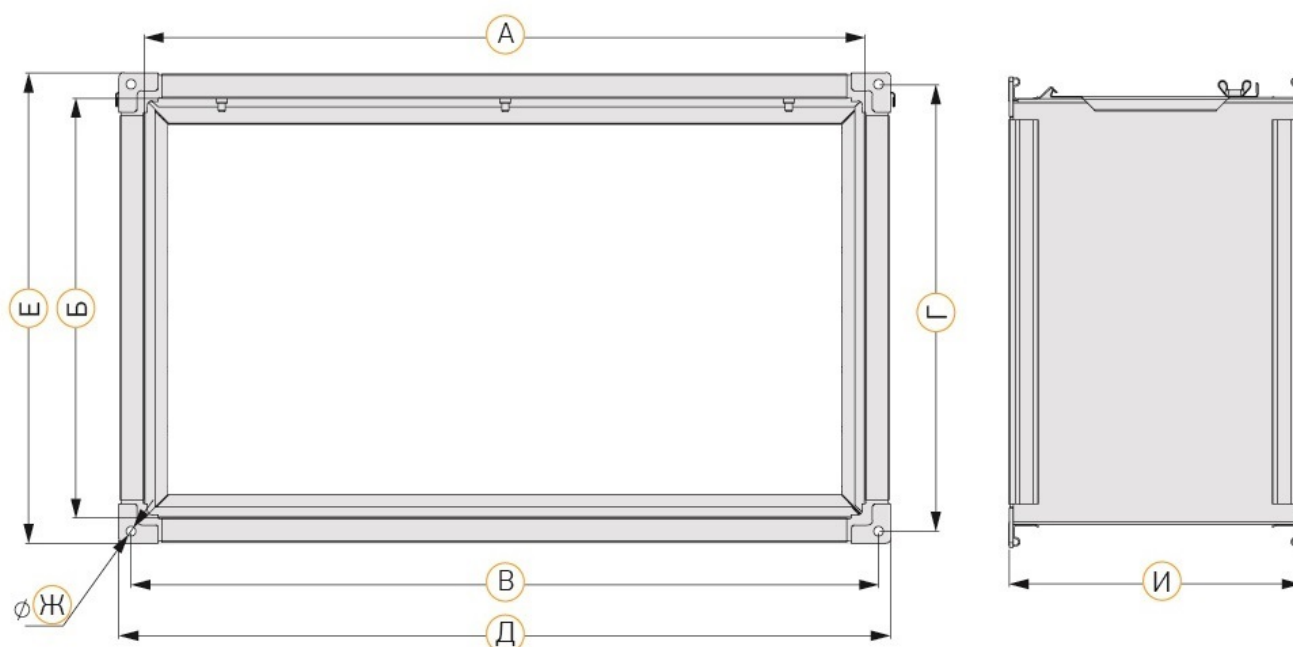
Внешний вид и основные размеры фильтров KPF
